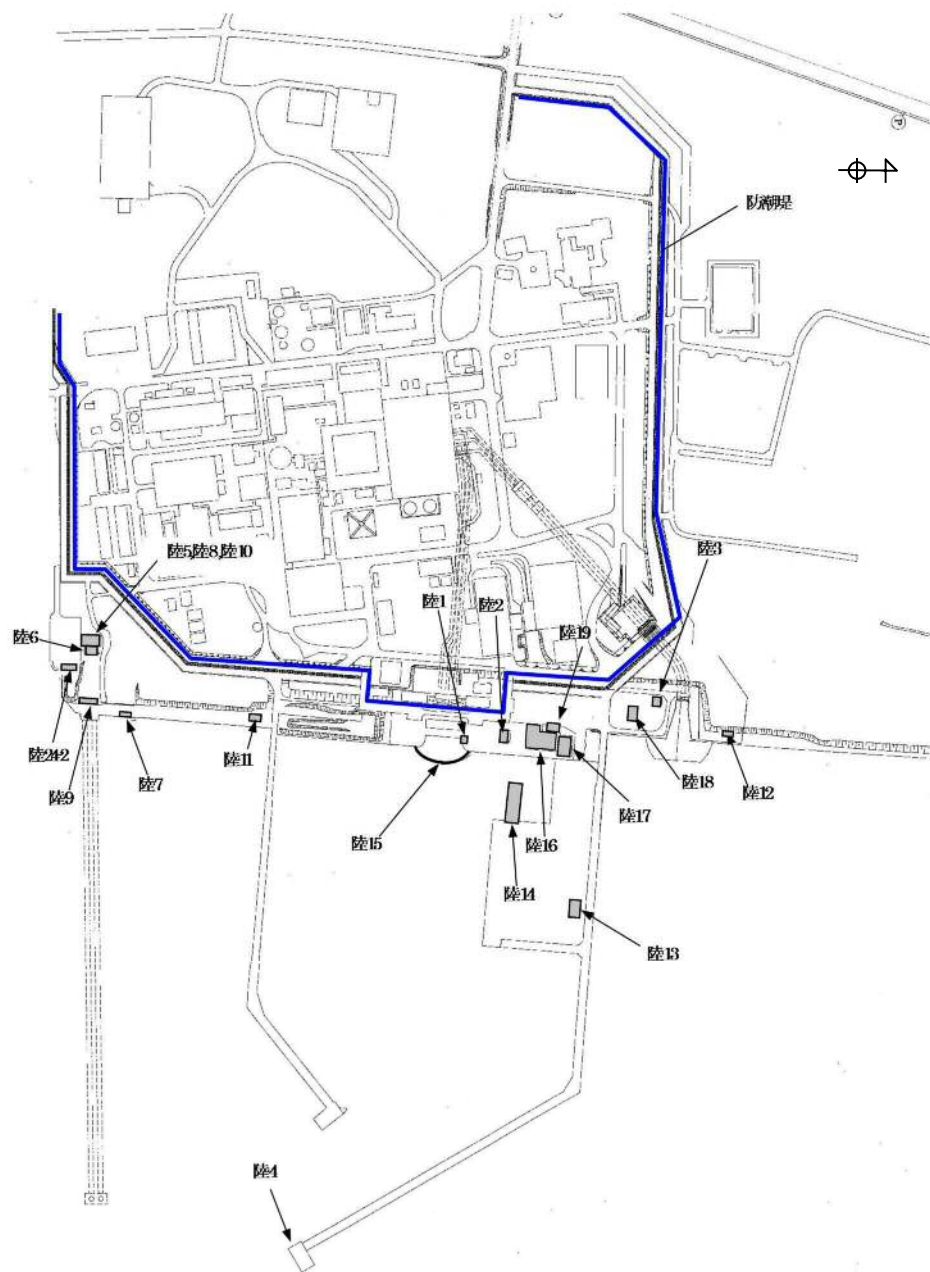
防潮堤東側エリアに設置されている構築物位置図
